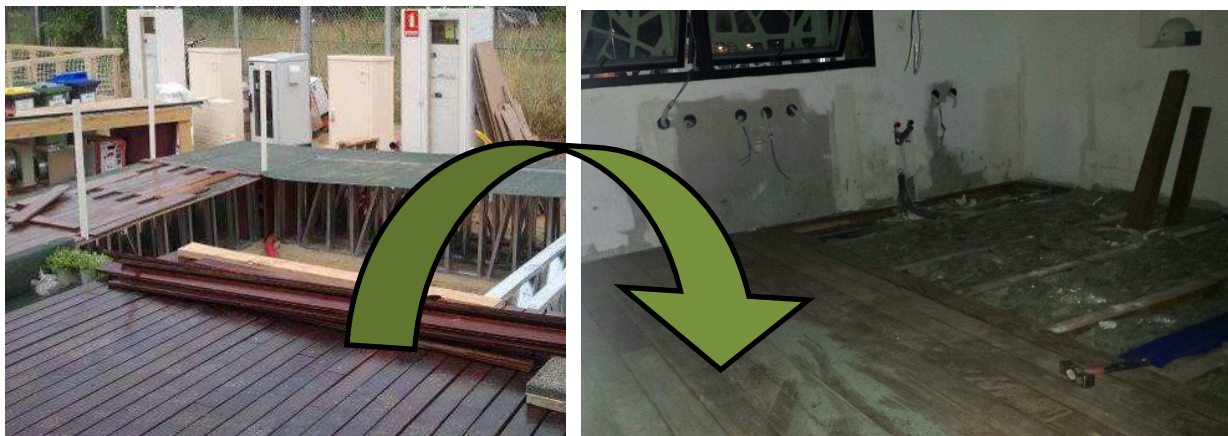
Reutilización de las tablillas de la rampa de éBRICKhouse2014 como soporte del pavimento de éBRICKhouse2016.
